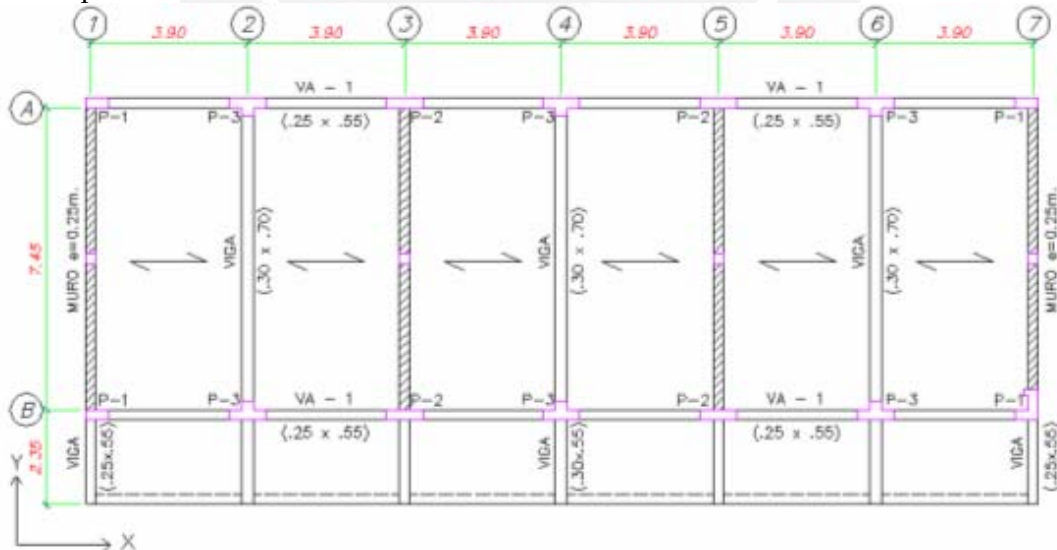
Planta del sistema estructural del edificio 780 actual
